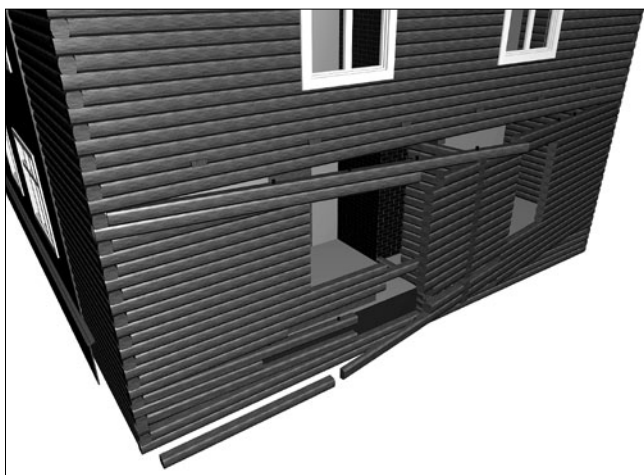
Взрывной волной подняло междуэтажное перекрытие и верхнюю часть сруба, нагели выдернуло из гнезд на уровнях цокольного и междуэтажного перекрытий. Последующее горизонтальное смещение конструкций здания в сторону торца привело к излому наружной стены
